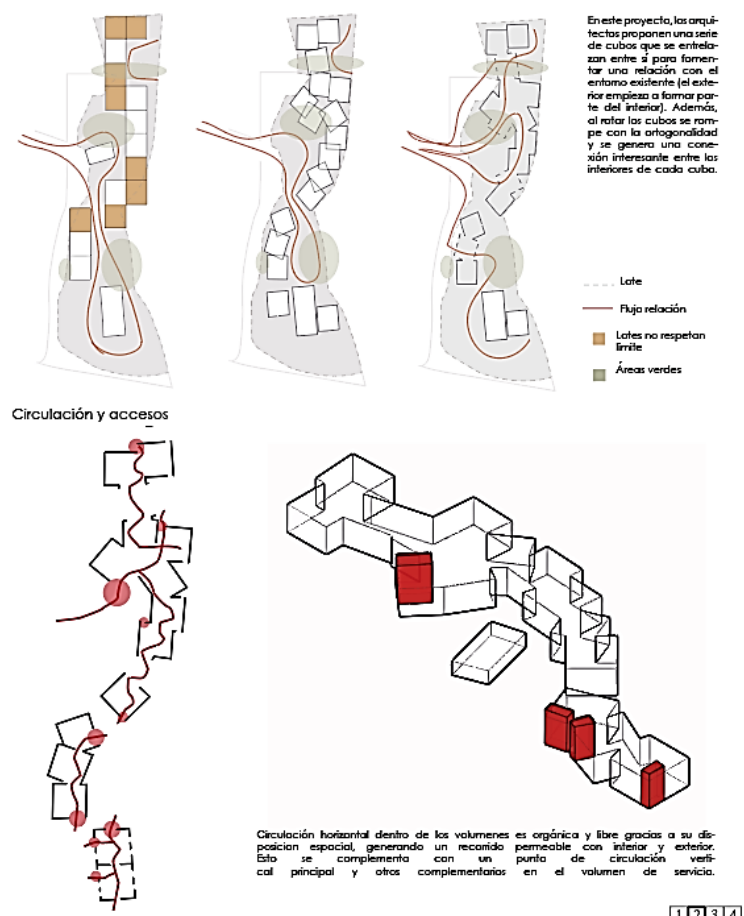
Análisis centro cultural village. Elaboración propia junto con Isabella Carrillo.
